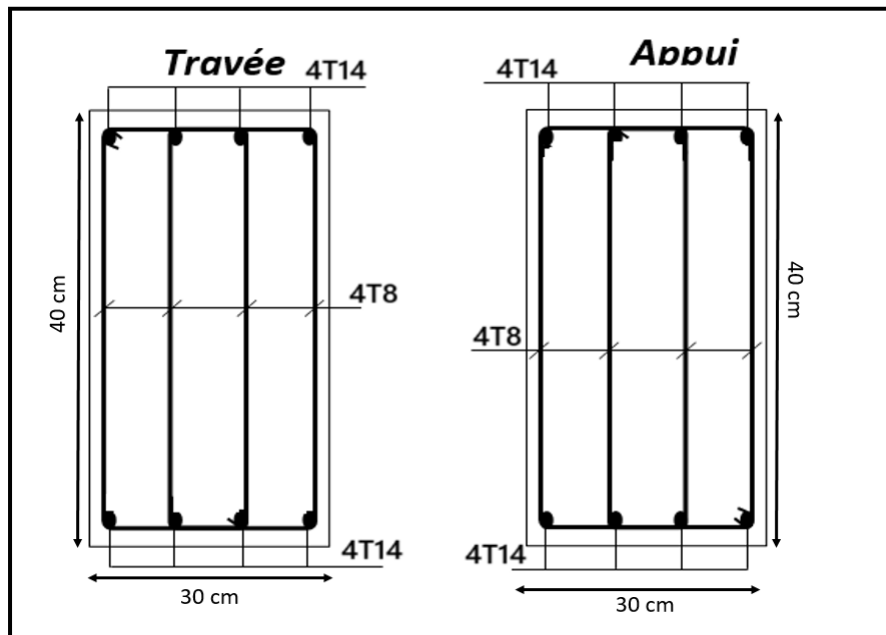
Schéma de Ferrailage des Poutres secondaire.
